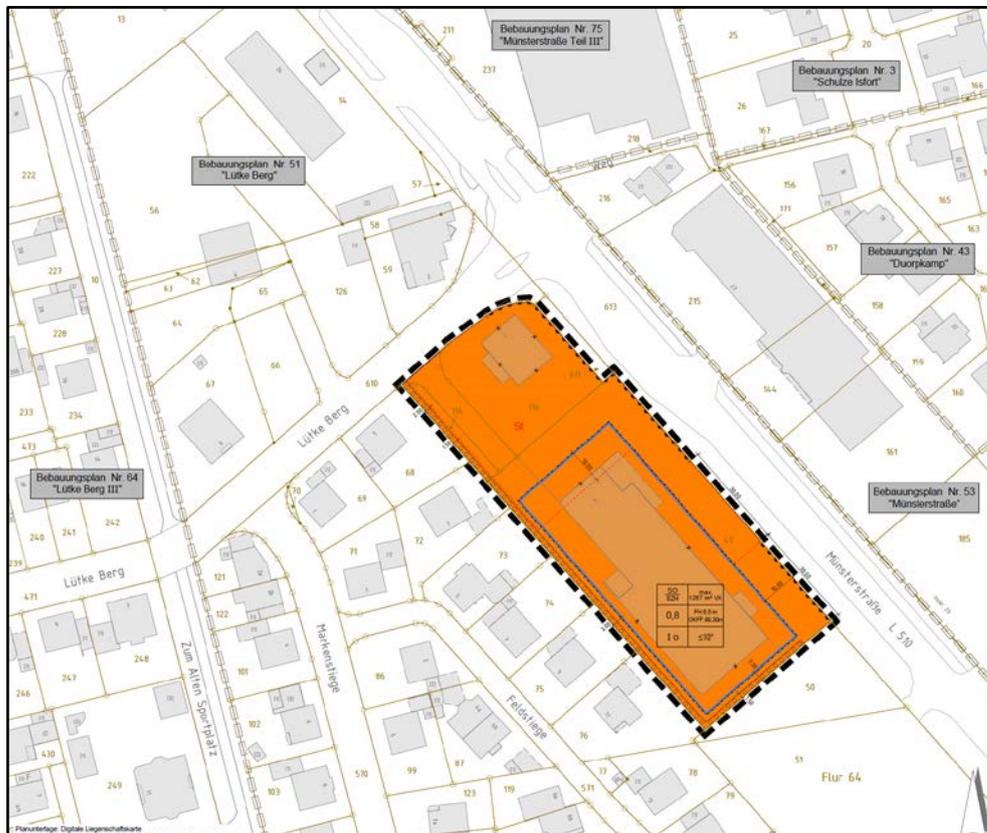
Auszug aus dem Entwurf der 4. Änderung des Bebauungsplanes [13] (unmaßstäblich)
